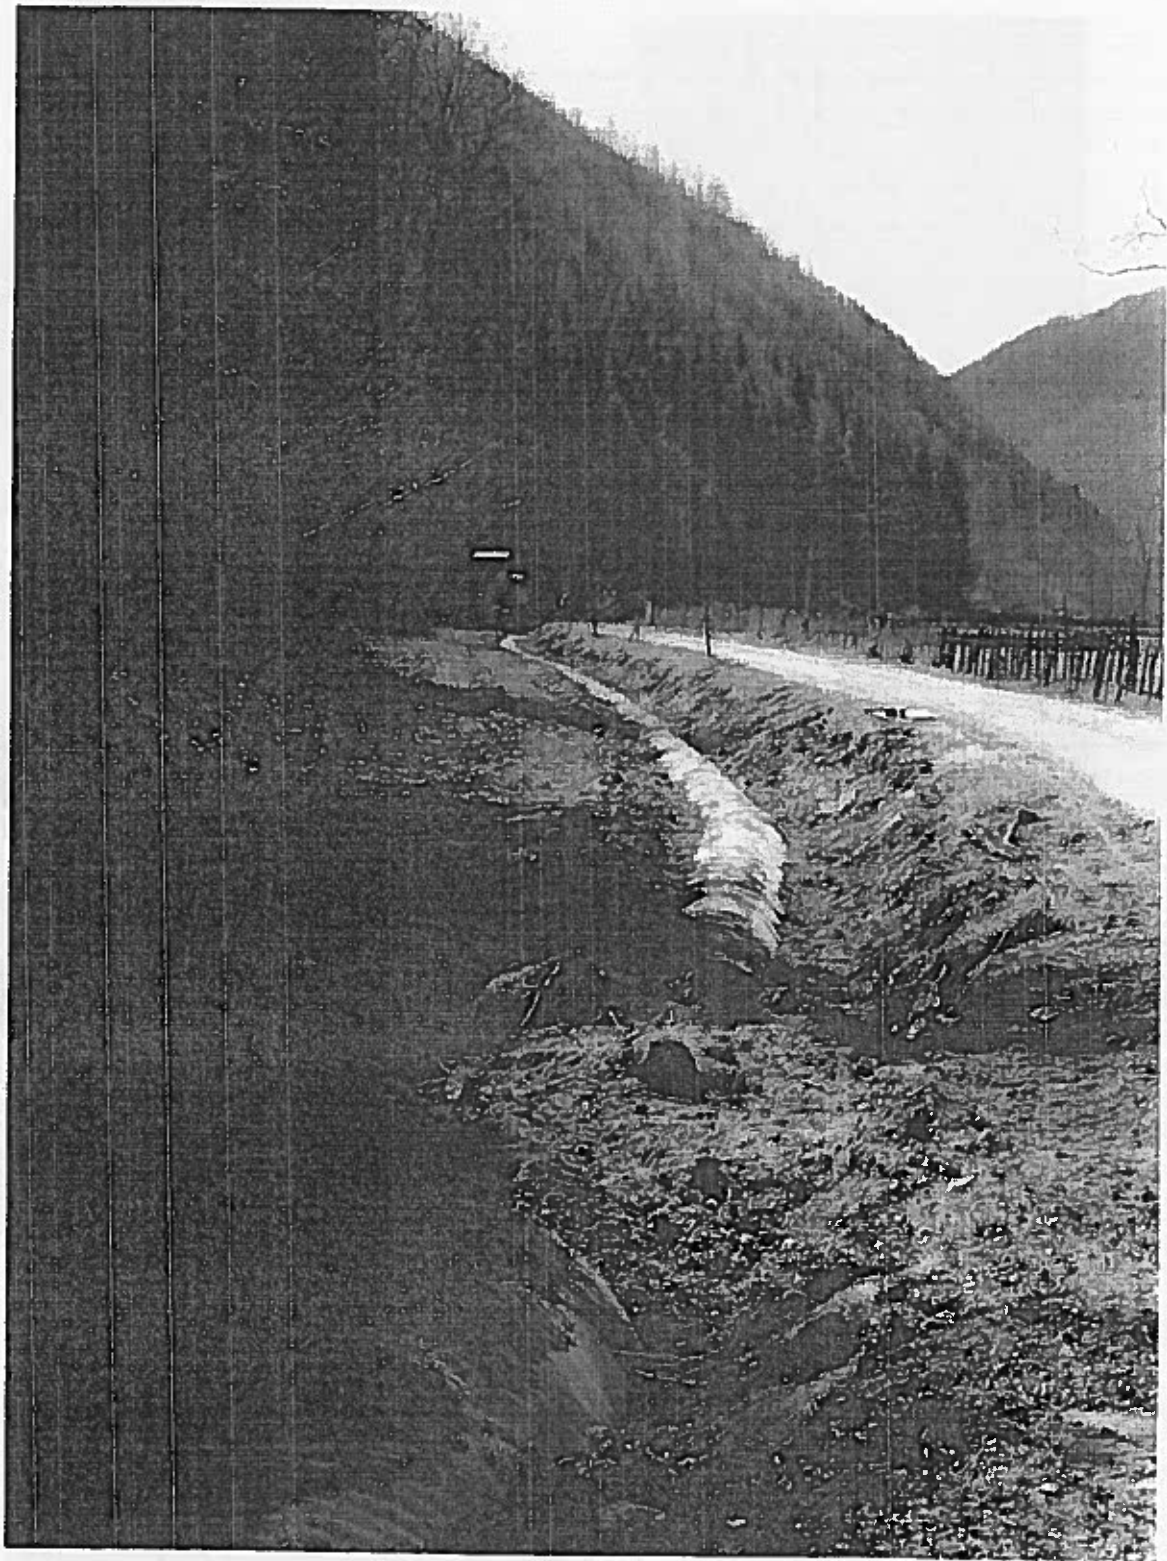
Limita ariei protejate în zona construcției MHC Taia
